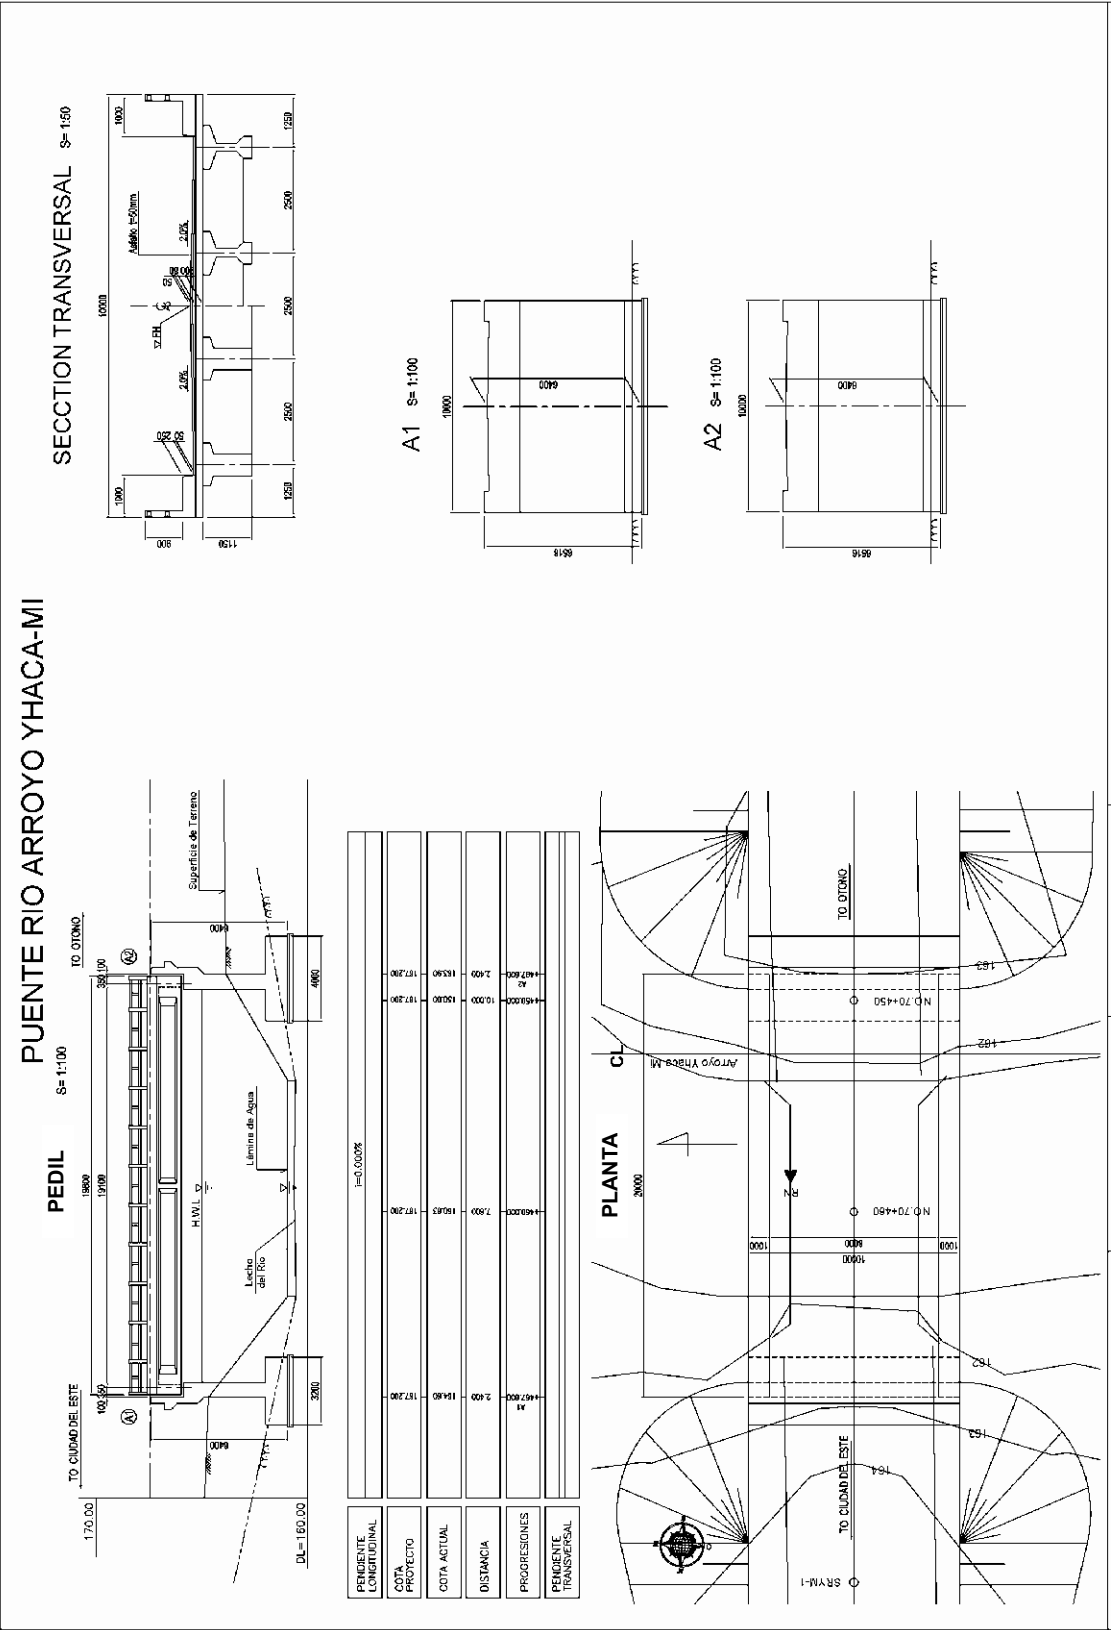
Puente Río Arroyo Yhaca-mi
